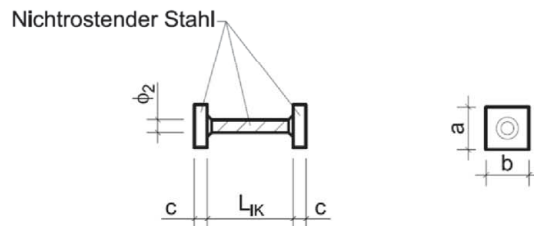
Druckelement aus Stahl mit angeschweißten Druckplatten, beidseitig bündig
